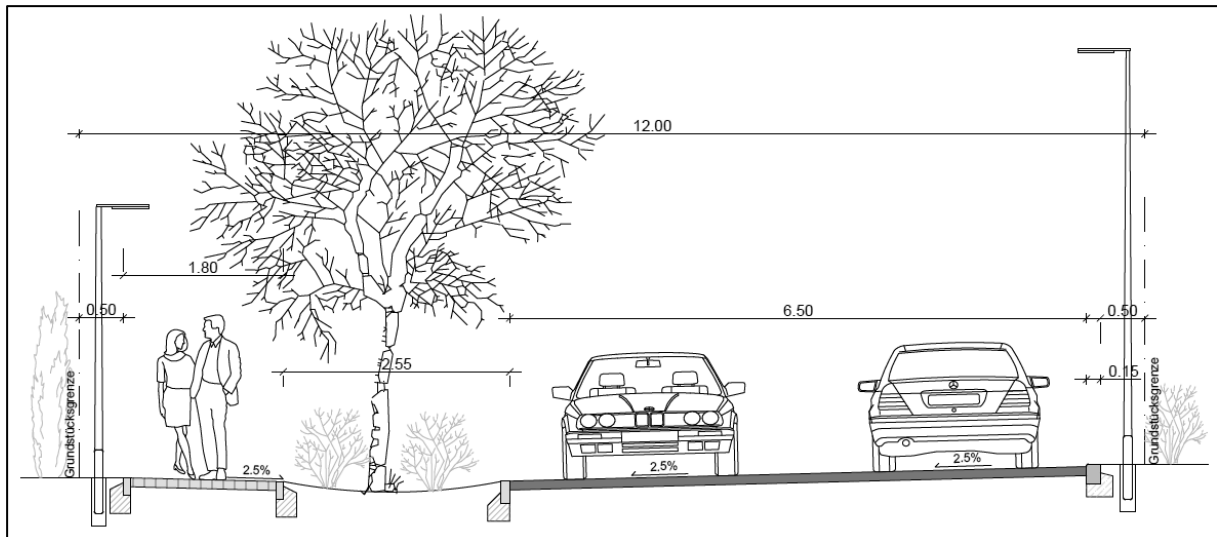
Regelquerschnitt der Planstraßen A und C gemäß Erschließungsvorplanung
